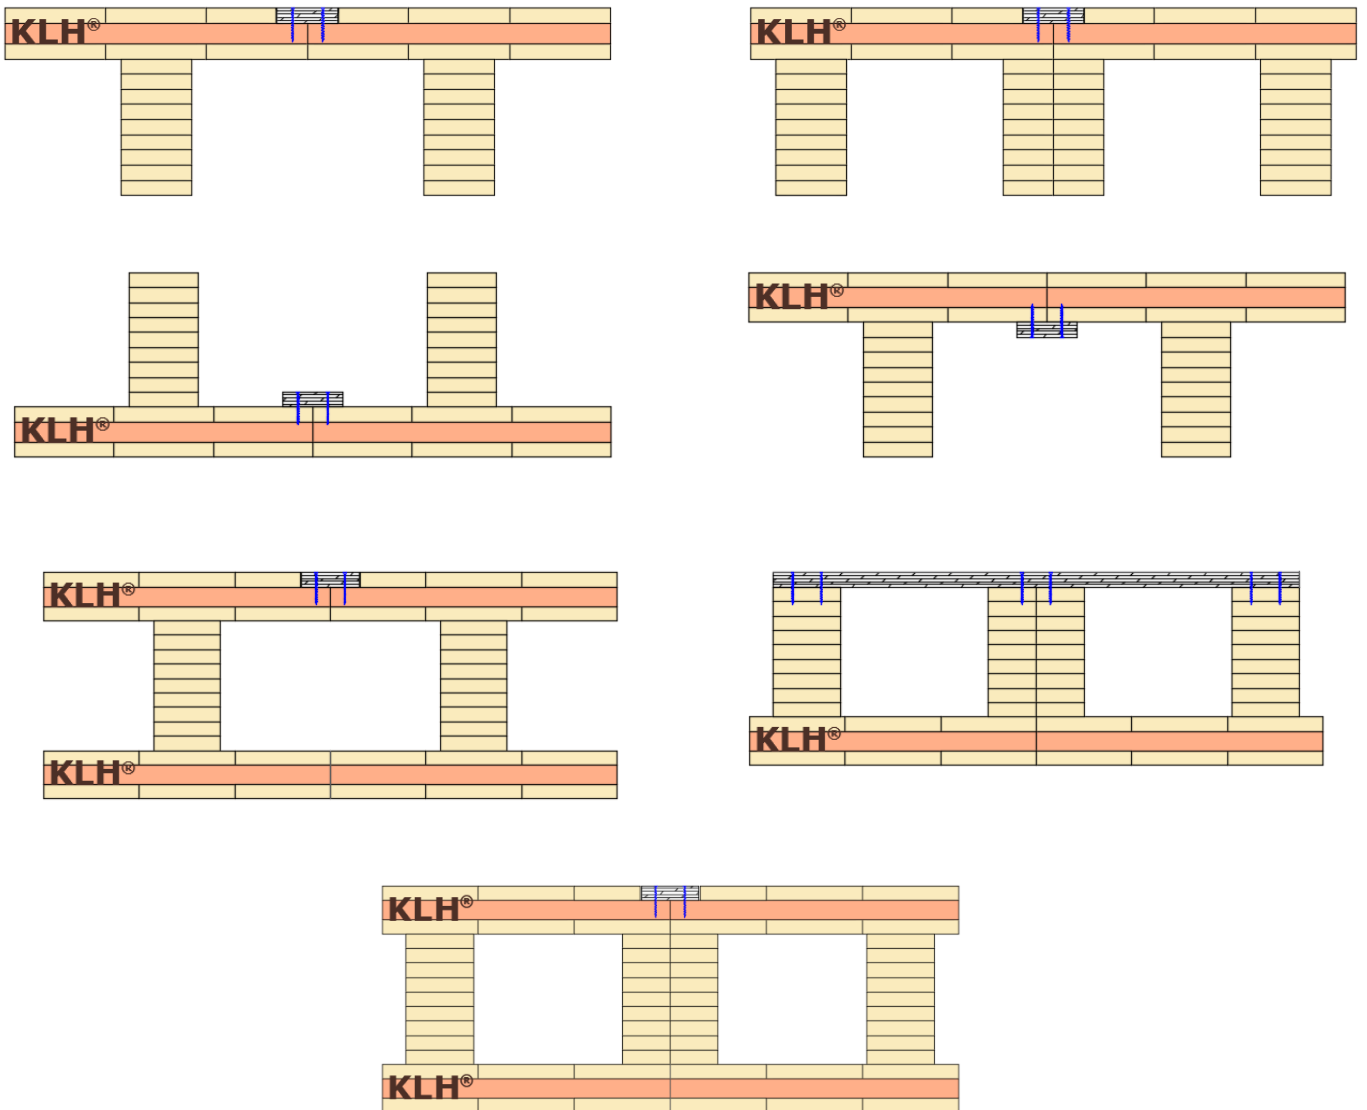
Assemblage par languette ou par panneau de fermeture à base de bois conforme au DTU 51.3 ou DTU 43.4
